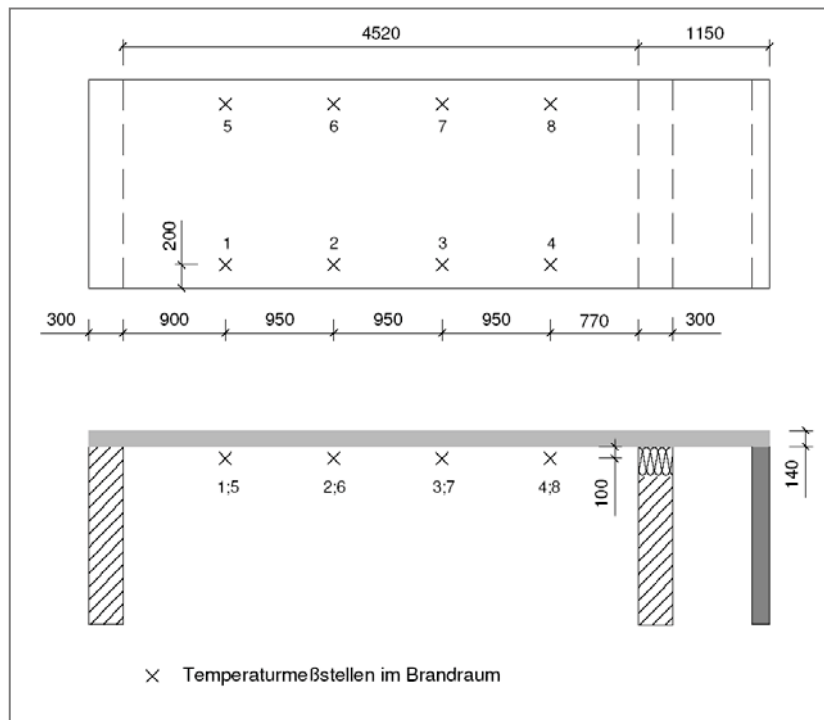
Prüfanordnung / Lage der Brandraummessstellen – Spannbetondeckenplatte 21000
